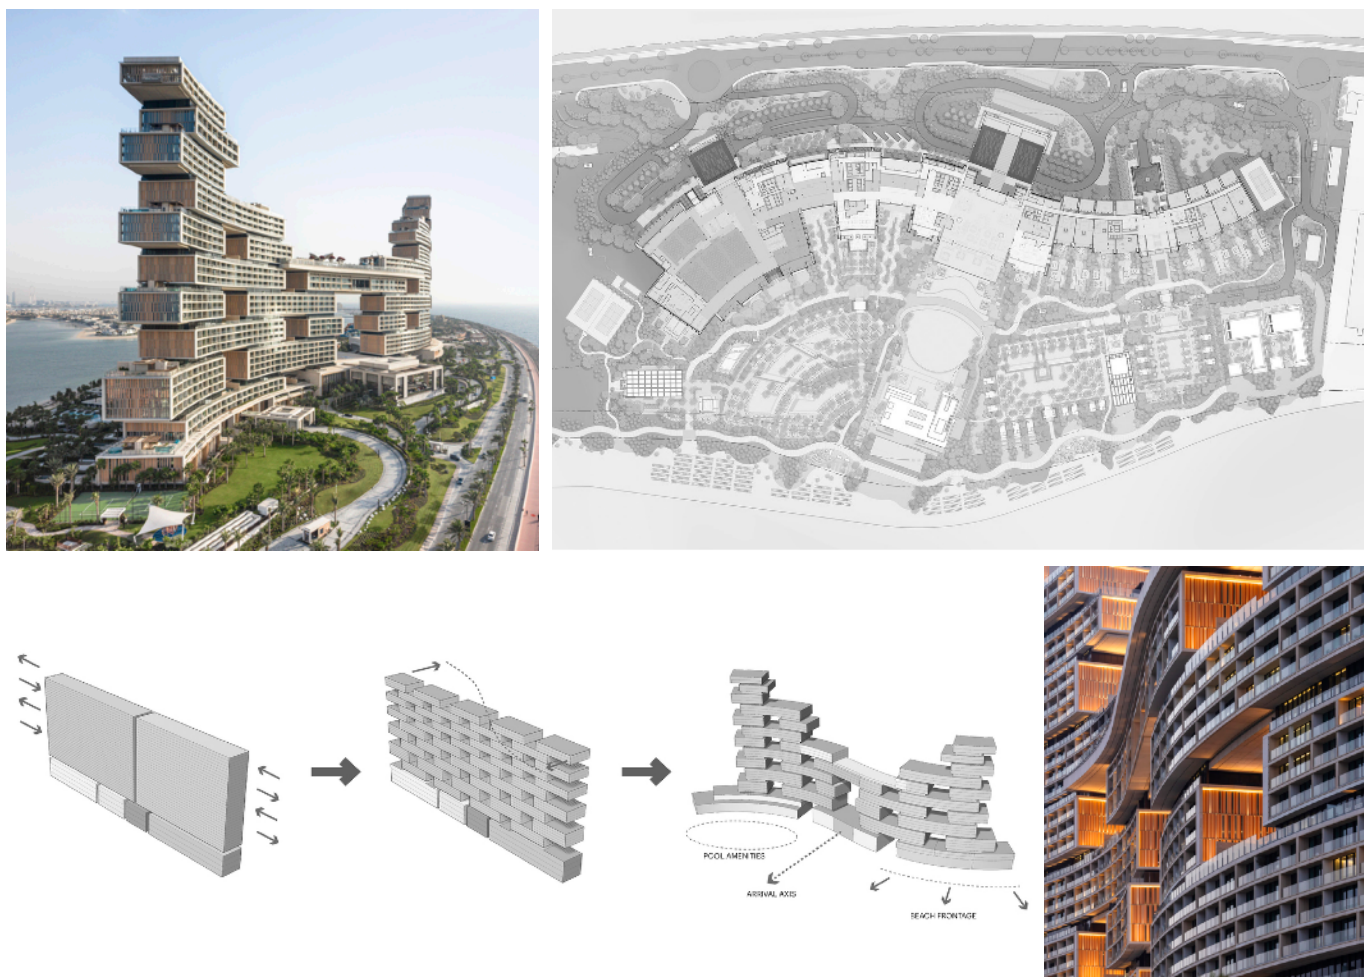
Готель « Atlantis The Royal», Пальма Джумейра, Дубай, ОАЕ, 2023 рік — перспективне зображення, генеральний план забудови, формоутворення фасаду, фрагмент фасаду [29]
